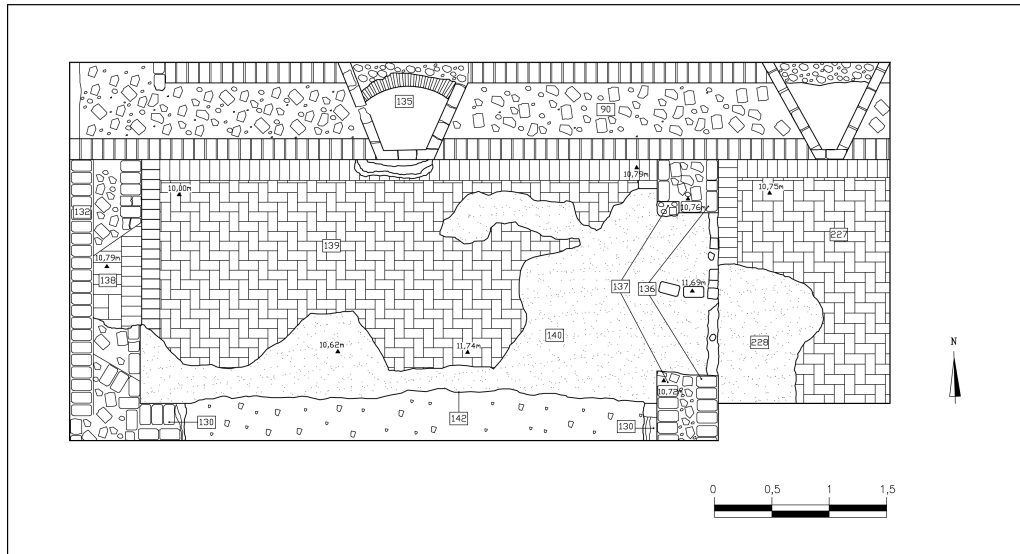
Figura IV. Corte 3. Planta I. Planta general de la denominada “Celda A”, situada en el extremo suroeste del claustro de Levante.
